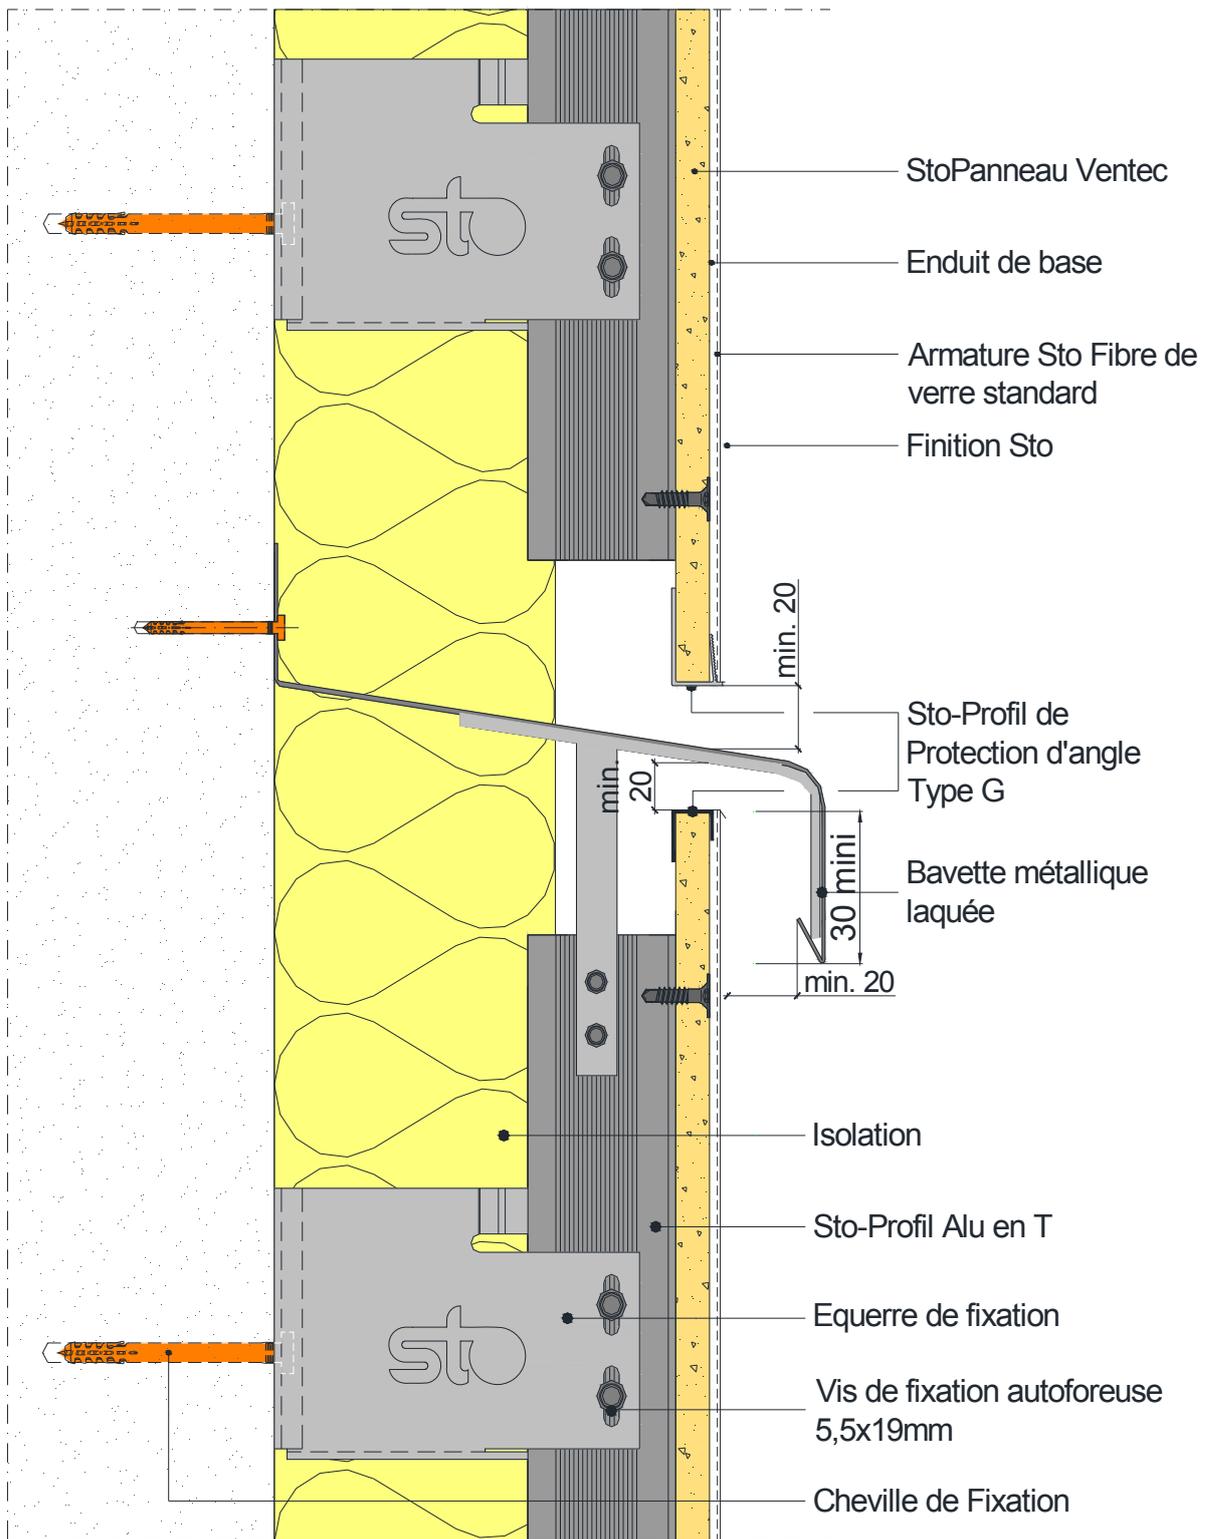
Coupe verticale - Fractionnement à joint ouvert - Ossature aluminium
